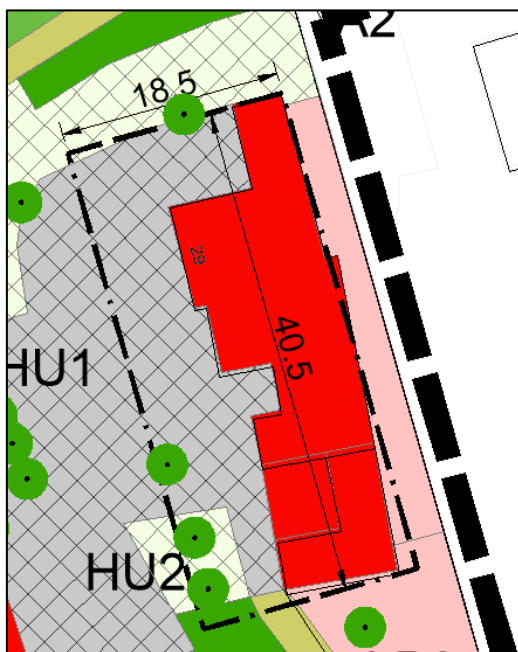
Verschnitt Baufenster Vereinsheim / Biotoptypenplan
